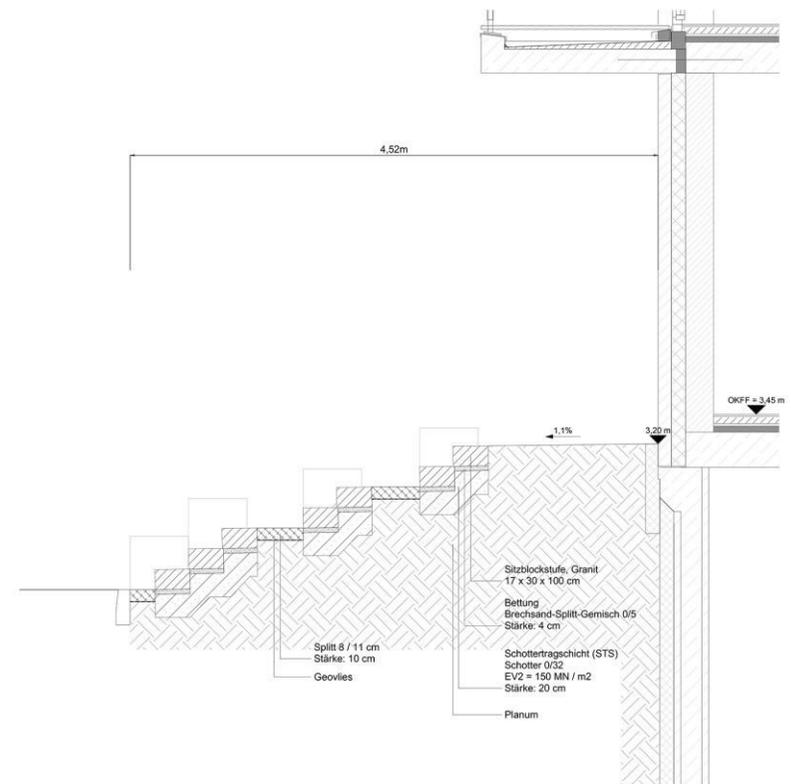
Schnitt der Sitztreppenanlage im rückwärtigen Gebäudebereich
